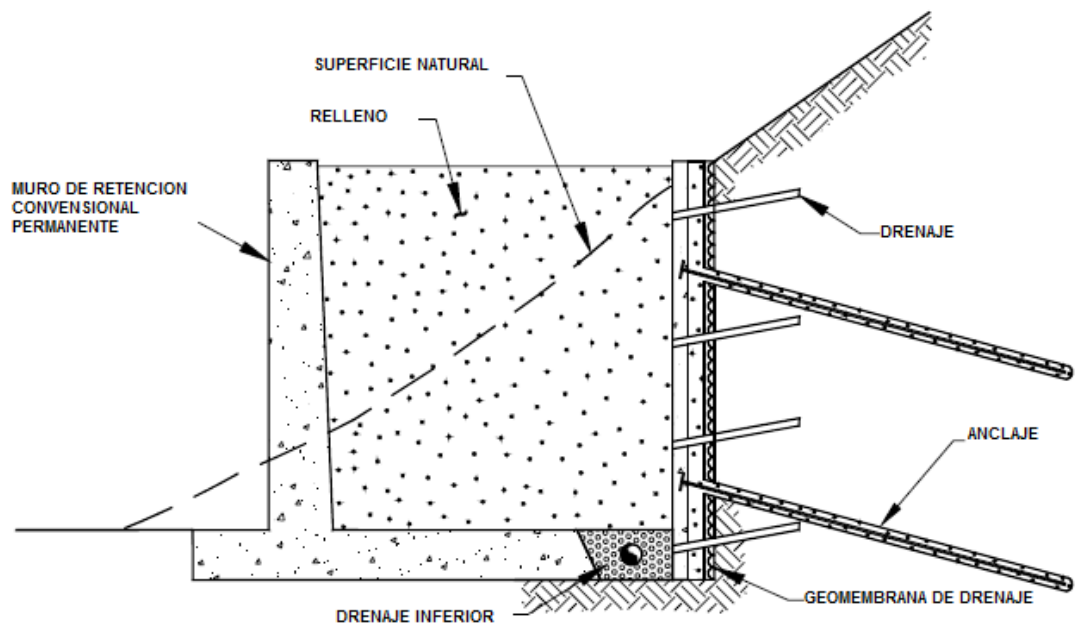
4 Muro de soil nailing para apuntalamiento temporal.
